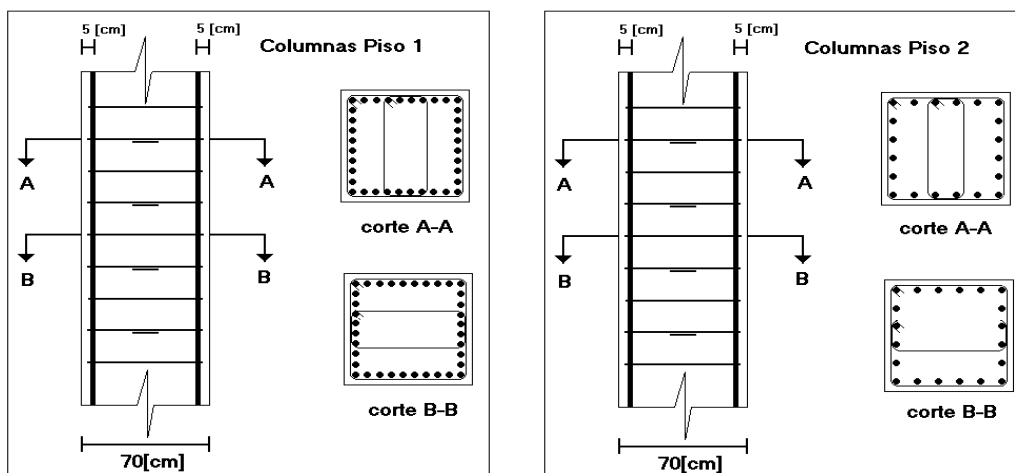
Detalle de la disposición de los estribos en las columnas del piso 1 y 2.
